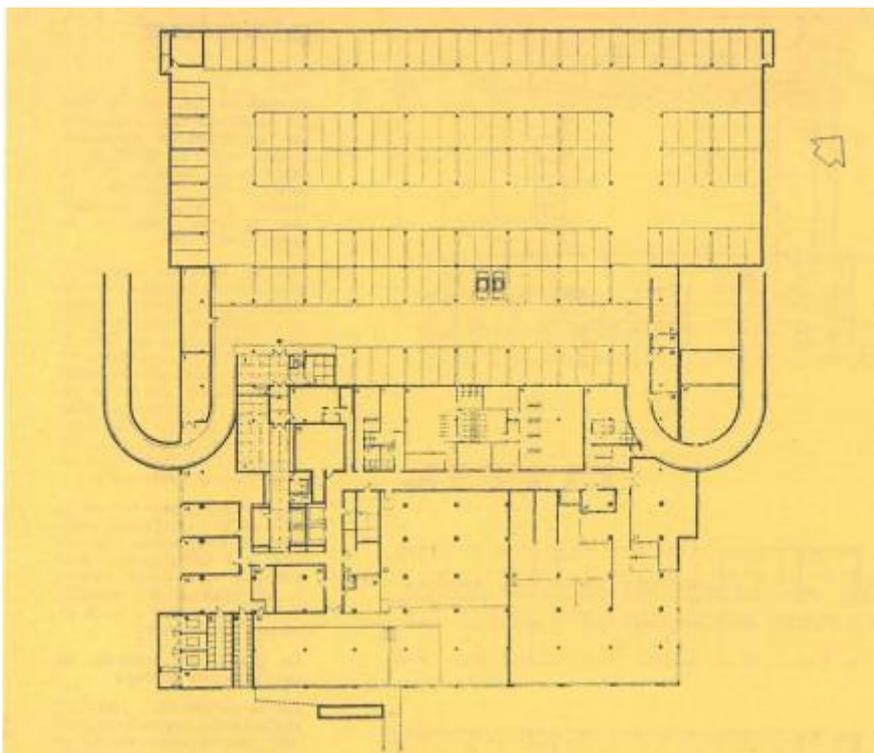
Planta da garagem, Hotel Intercontinental, Frankfurt
